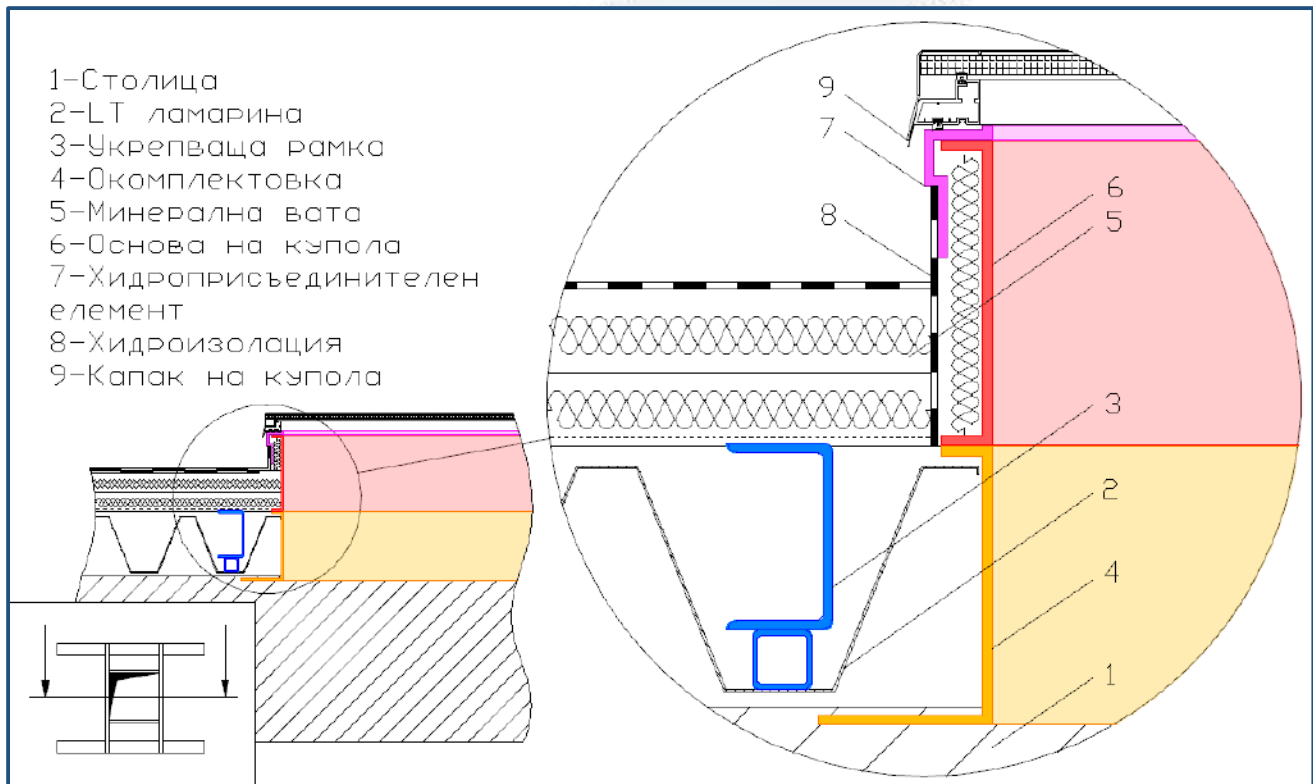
Инсталационна схема №1 - послоен монтаж
